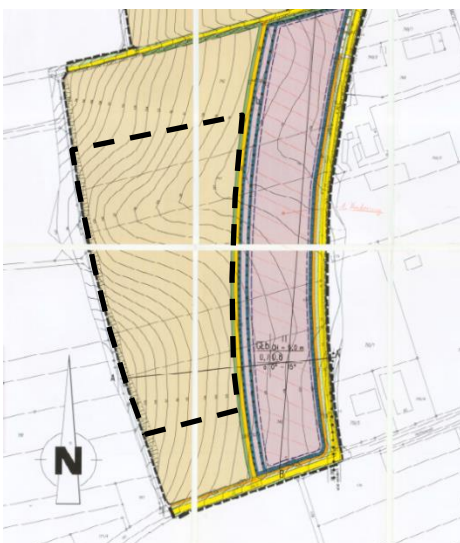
Bestehender rechtskräftiger Bebauungsplan mit Geltungsbereich (schwarz gestrichelt), o. M.
